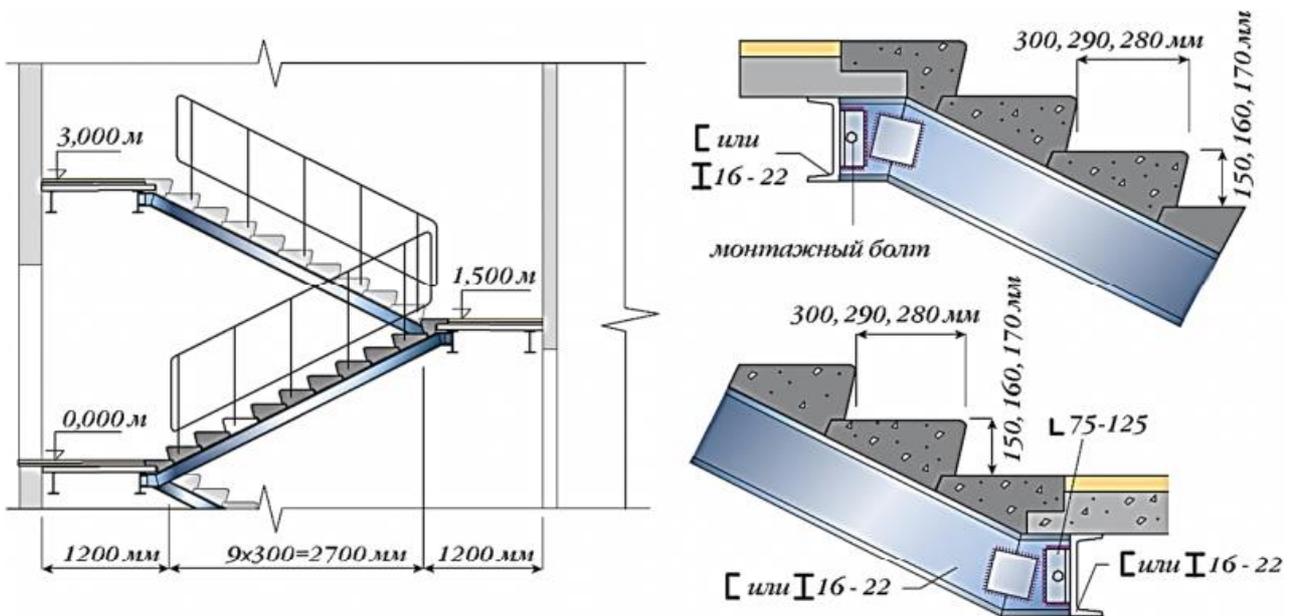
Лестницы из сборных железобетонных ступеней по стальным косоурам
